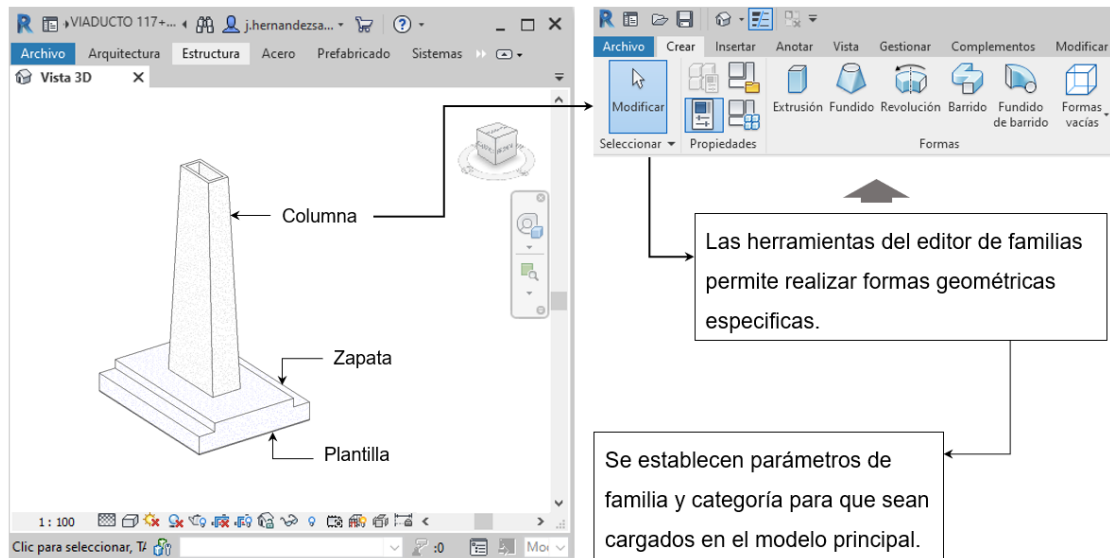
Modelado de zapatas y columnas de las Pilas. Fuente: Elaboración propia
